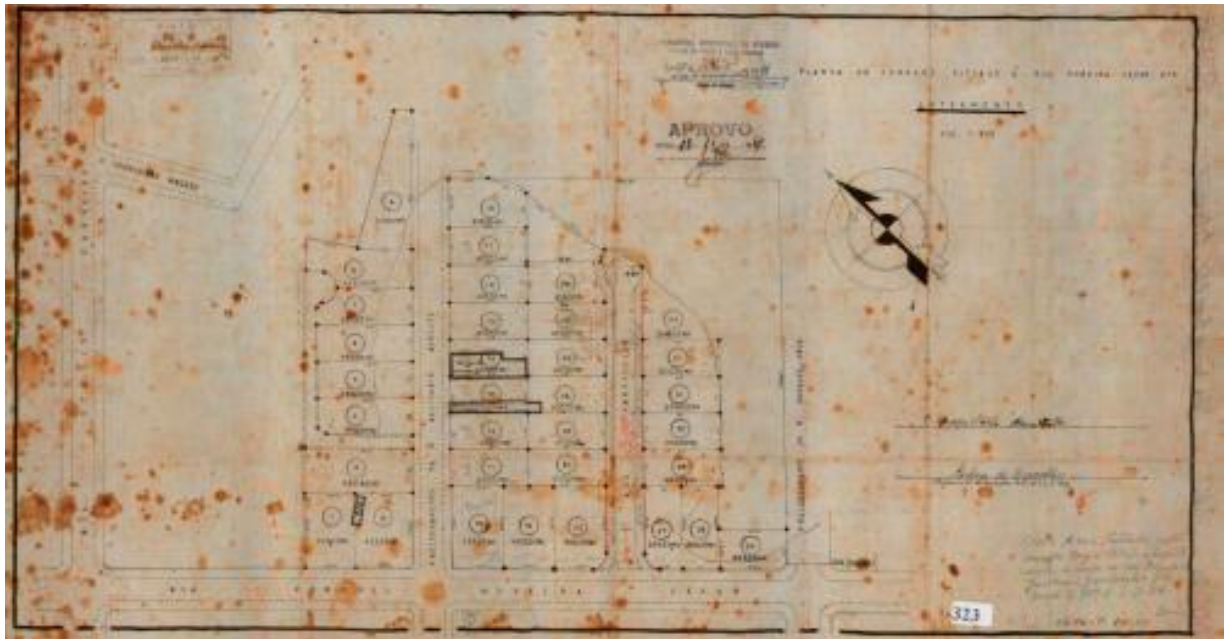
Planta de Arruamento das Ruas Belizário Augusto e Guilherme Greenhalgh.
